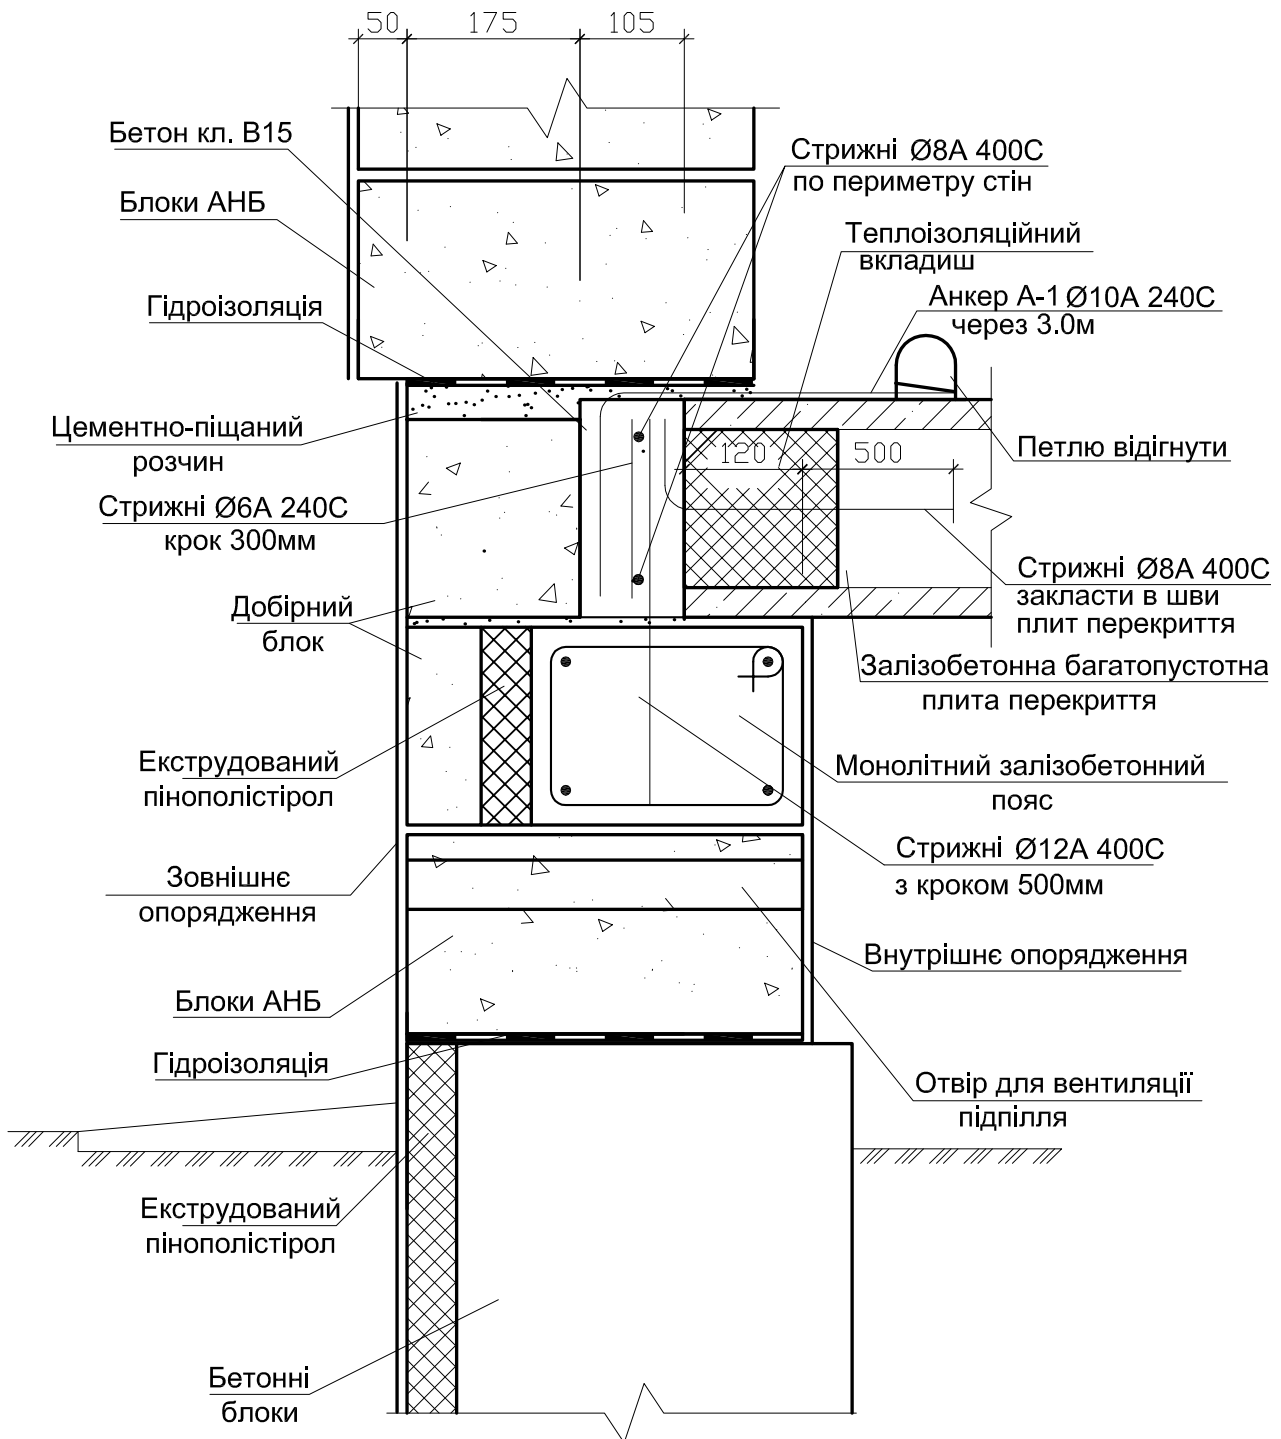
2-4. Влаштування цоколя при залізобетонному багатопустотному перекритті
